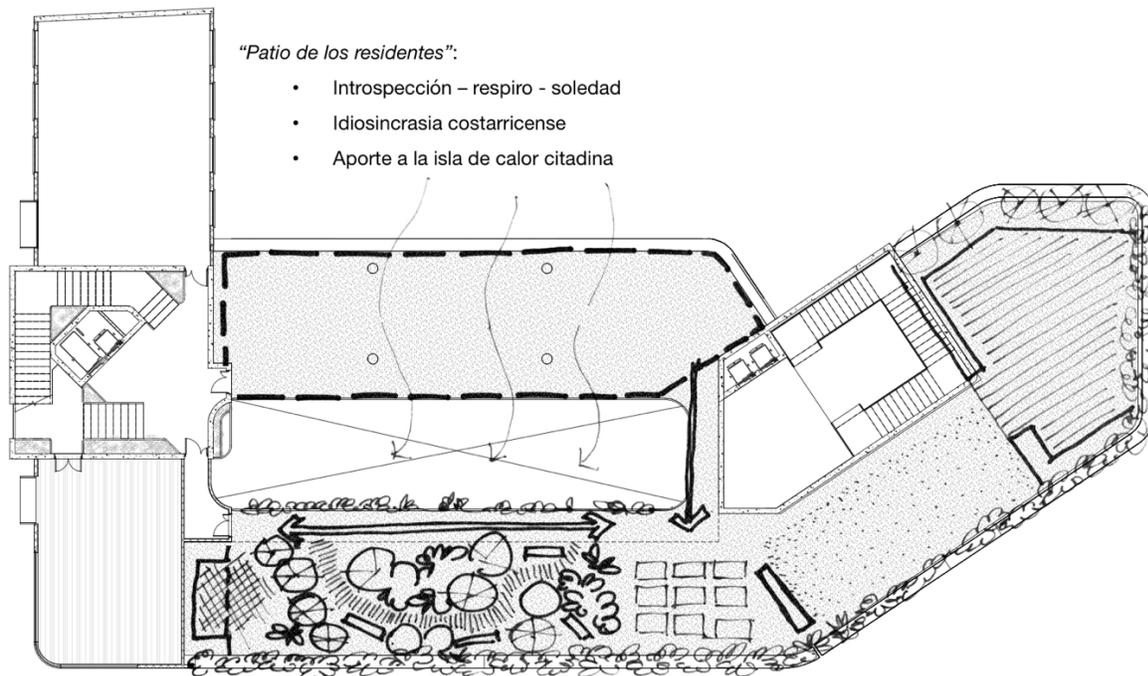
Sketch en planta de la cubierta verde [Elaboración propia]
